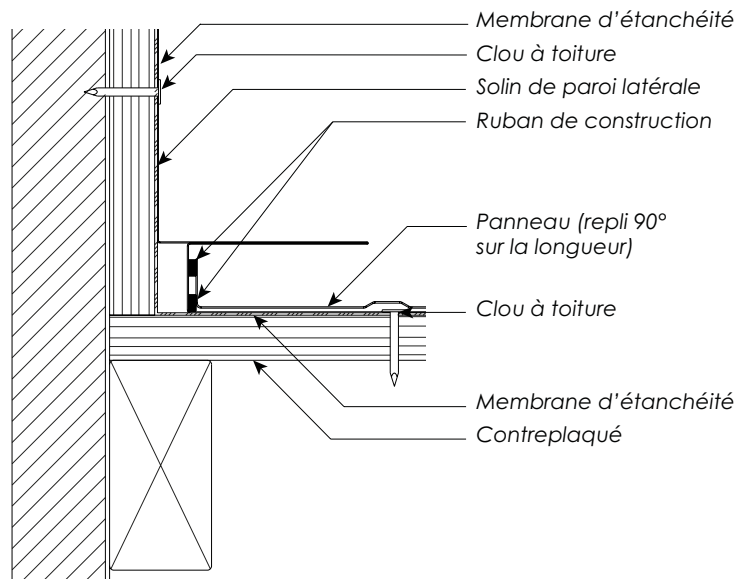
c | Vue en coupe du solin de paroi latérale – méthode 2
